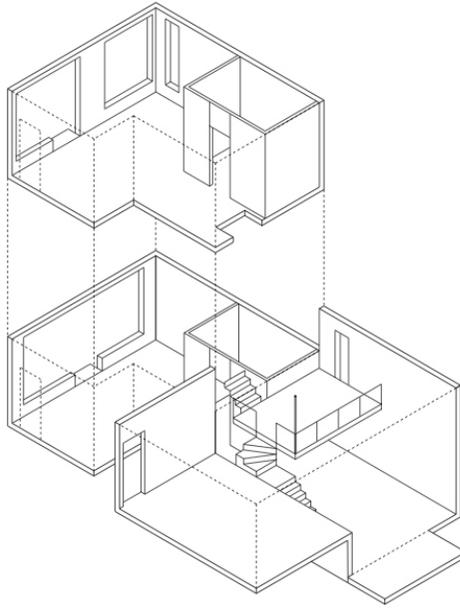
Mischen Possible, Grundriss 5.OG
